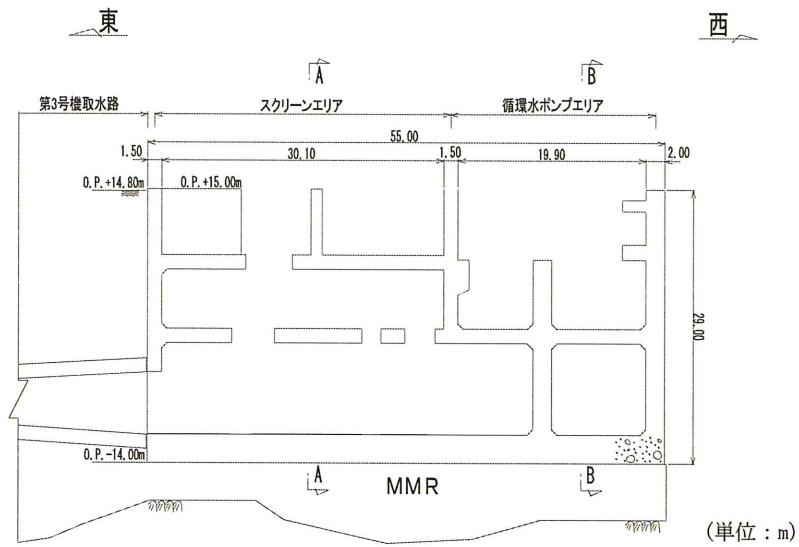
第 3 号機海水ポンプ室断面図 (C-C 断面)
